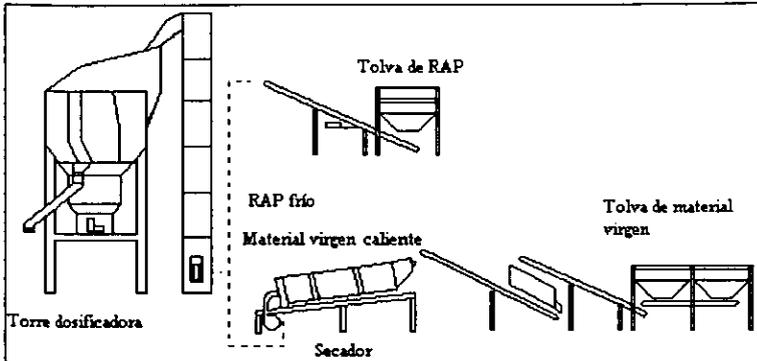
Manejo del RAP en el elevador caliente de una planta dosificadora.
